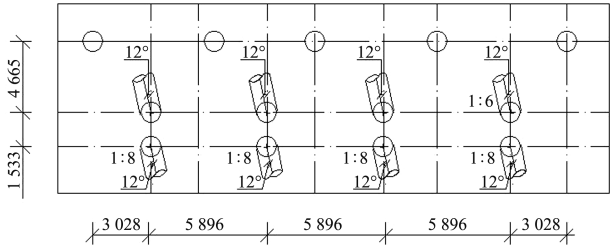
海侧结构 PHC 桩平面布置 (单位: mm)
